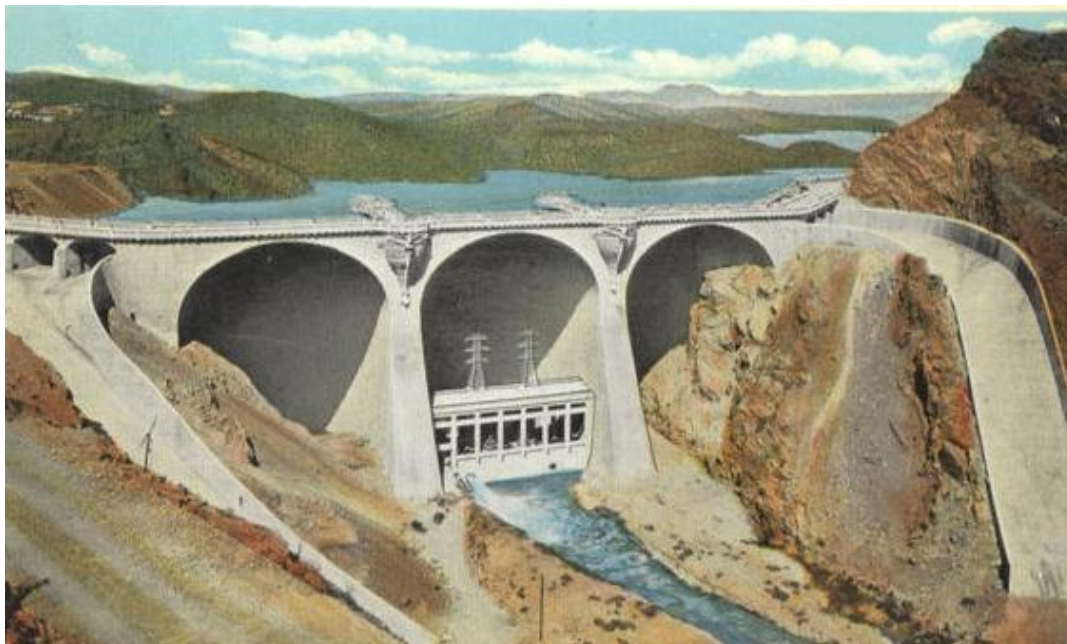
Vista de jusante da barragem de Coolidge (EUA, 1928) [67]
